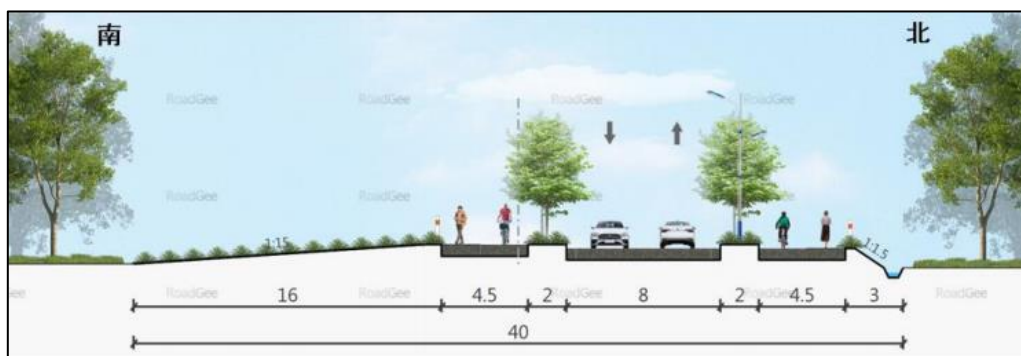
起点~合作公路标准横断面布置图 单位：m
